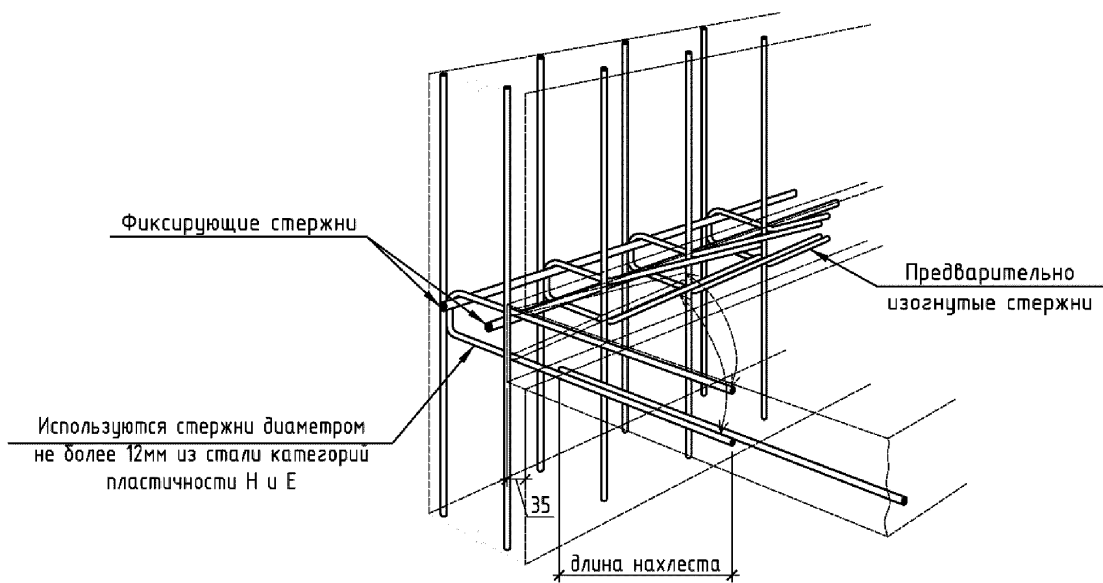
Узел сопряжения перекрытия и стены
